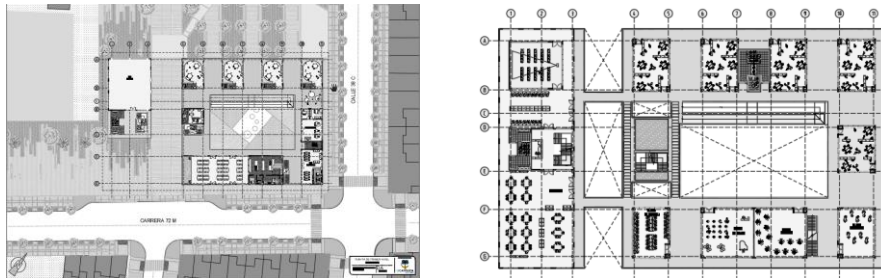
Plantas arquitectónicas nivel 1 y 2
